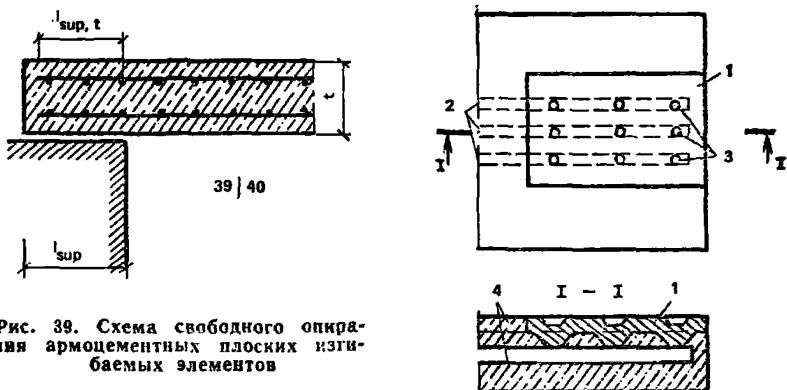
Схема свободного опирания армоцементных плоских изгибаемых элементов
